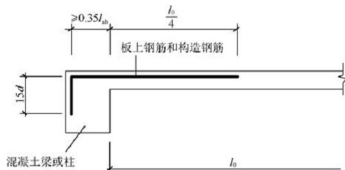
与混凝土梁、柱整浇的板上部构造钢筋
